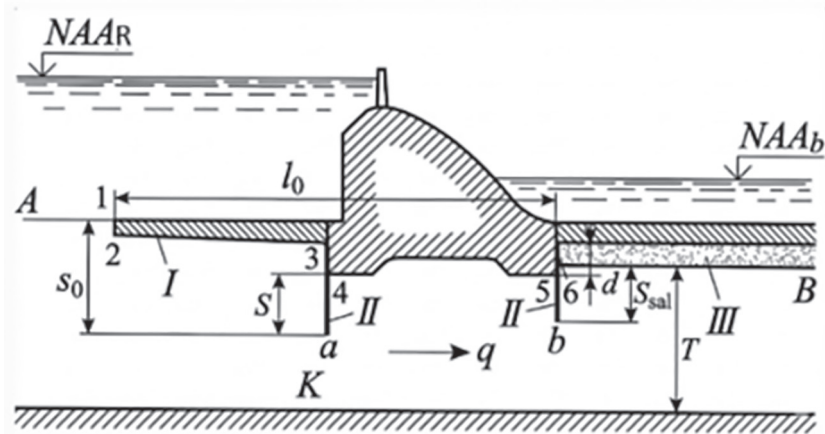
Carpeta y presa sin drenaje horizontal (esquema A).
